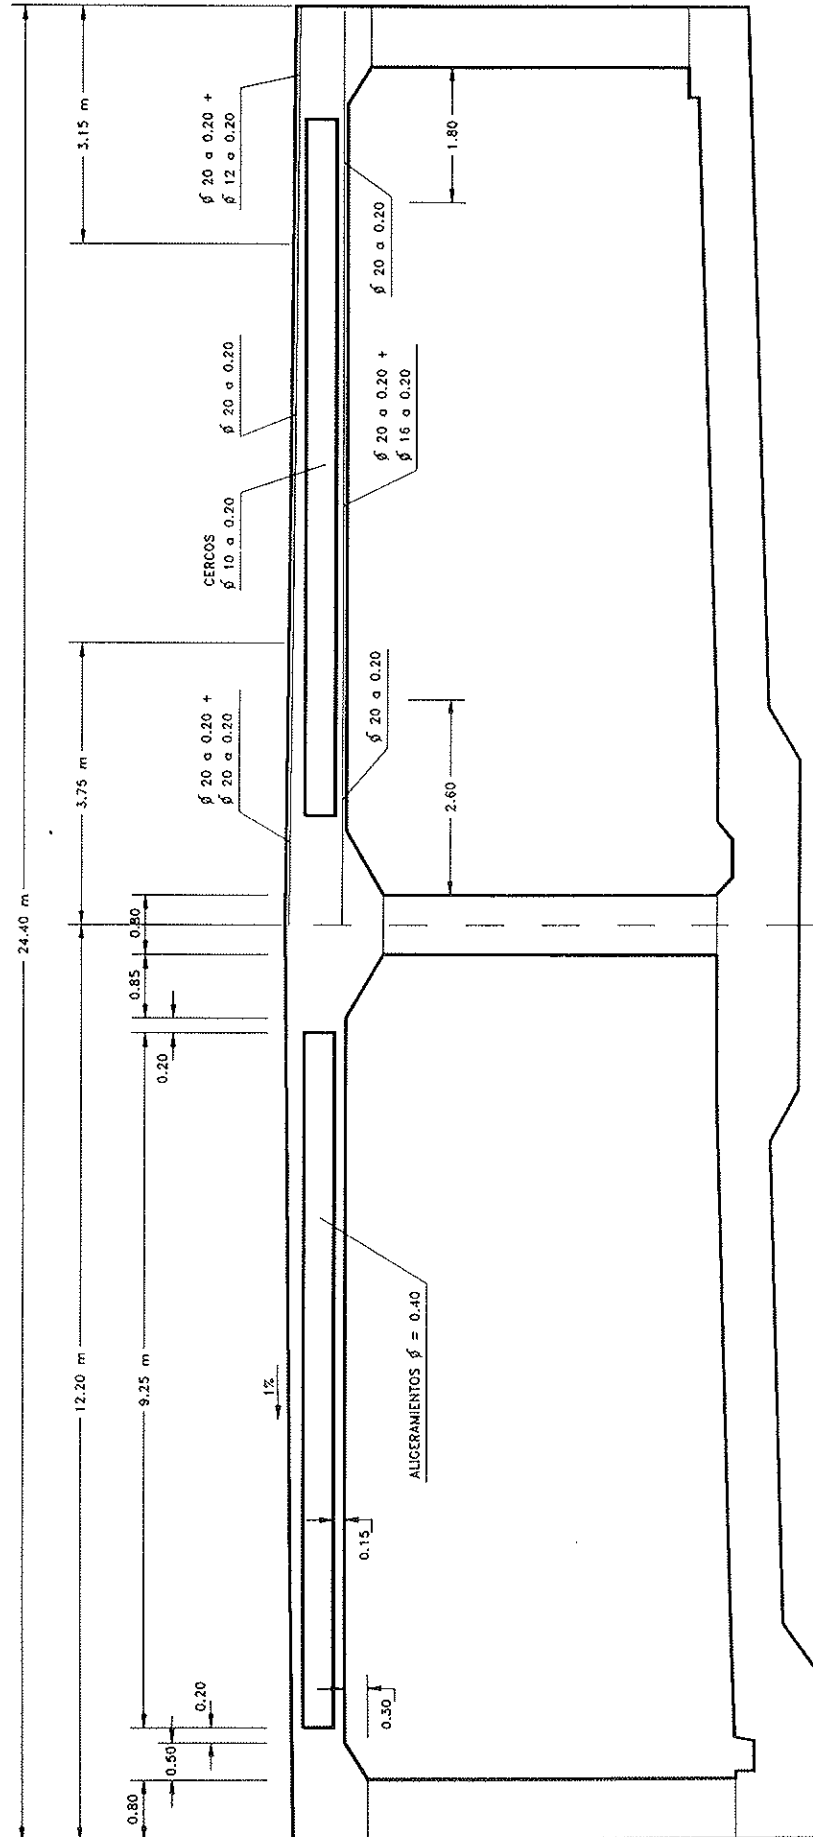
Sección tipo. Geometría y armado de la losa superior.
